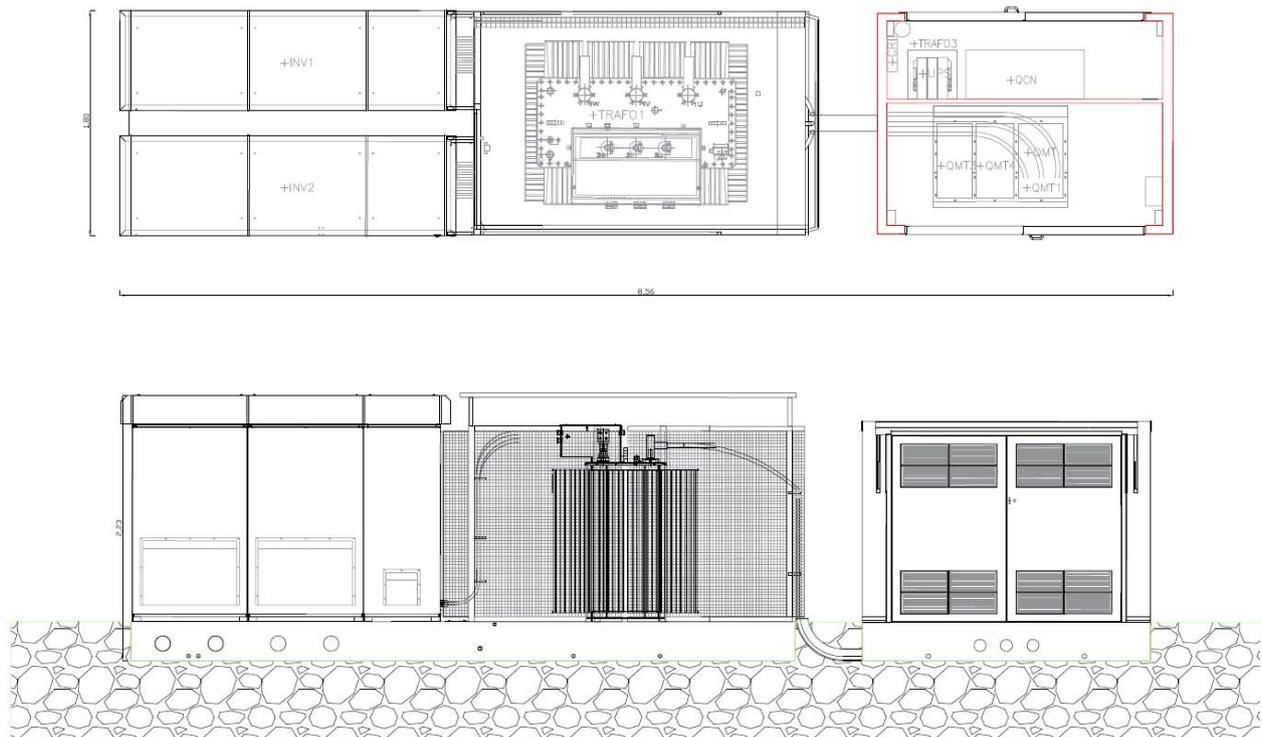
Pianta e prospetto cabina di trasformazione bt/MT
